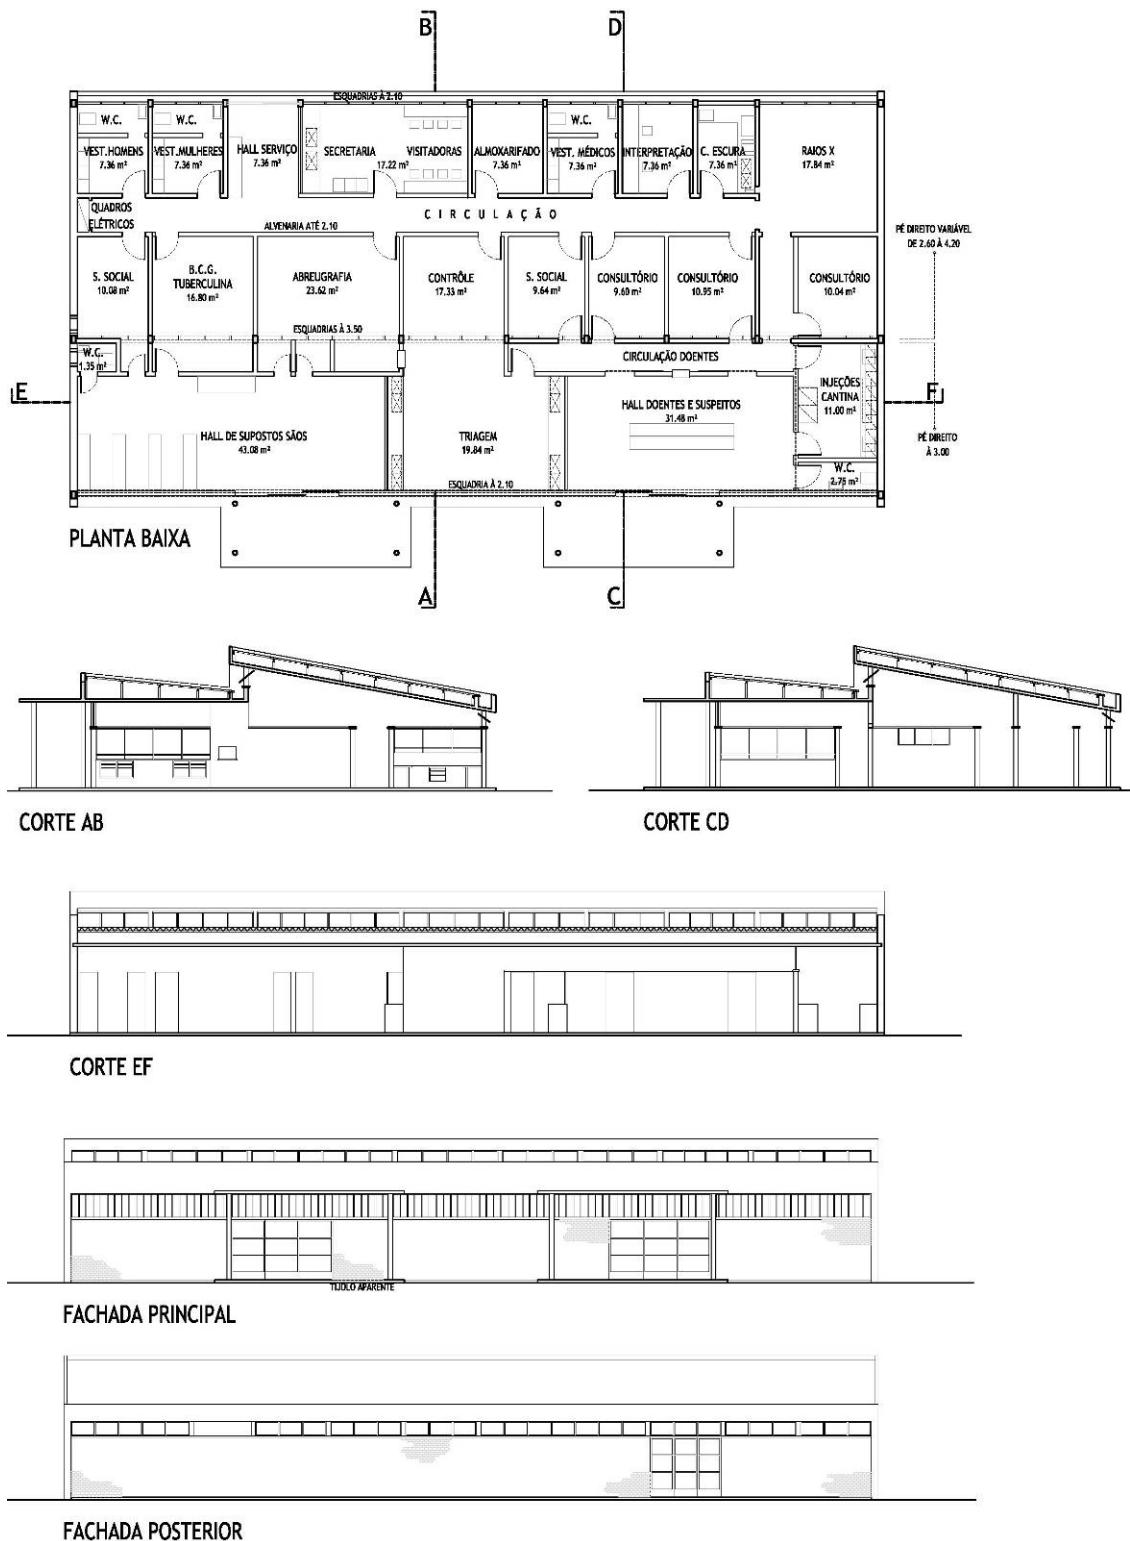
Planta Baixa, Cortes e Fachadas do Dispensário de Olinda, de 27 de Abril de 1957.
